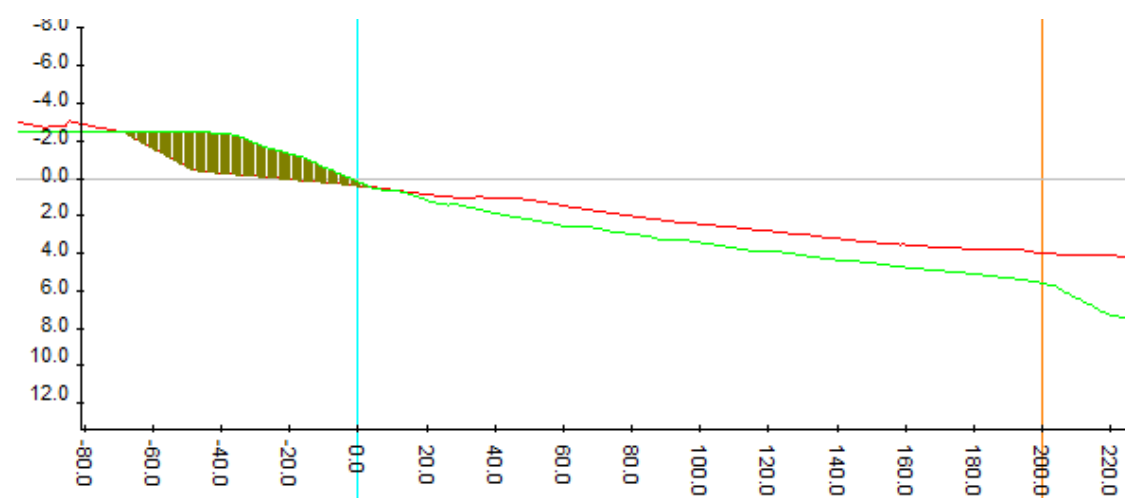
Perfil Alternativa 1. Cota de berma: +2,50 m
